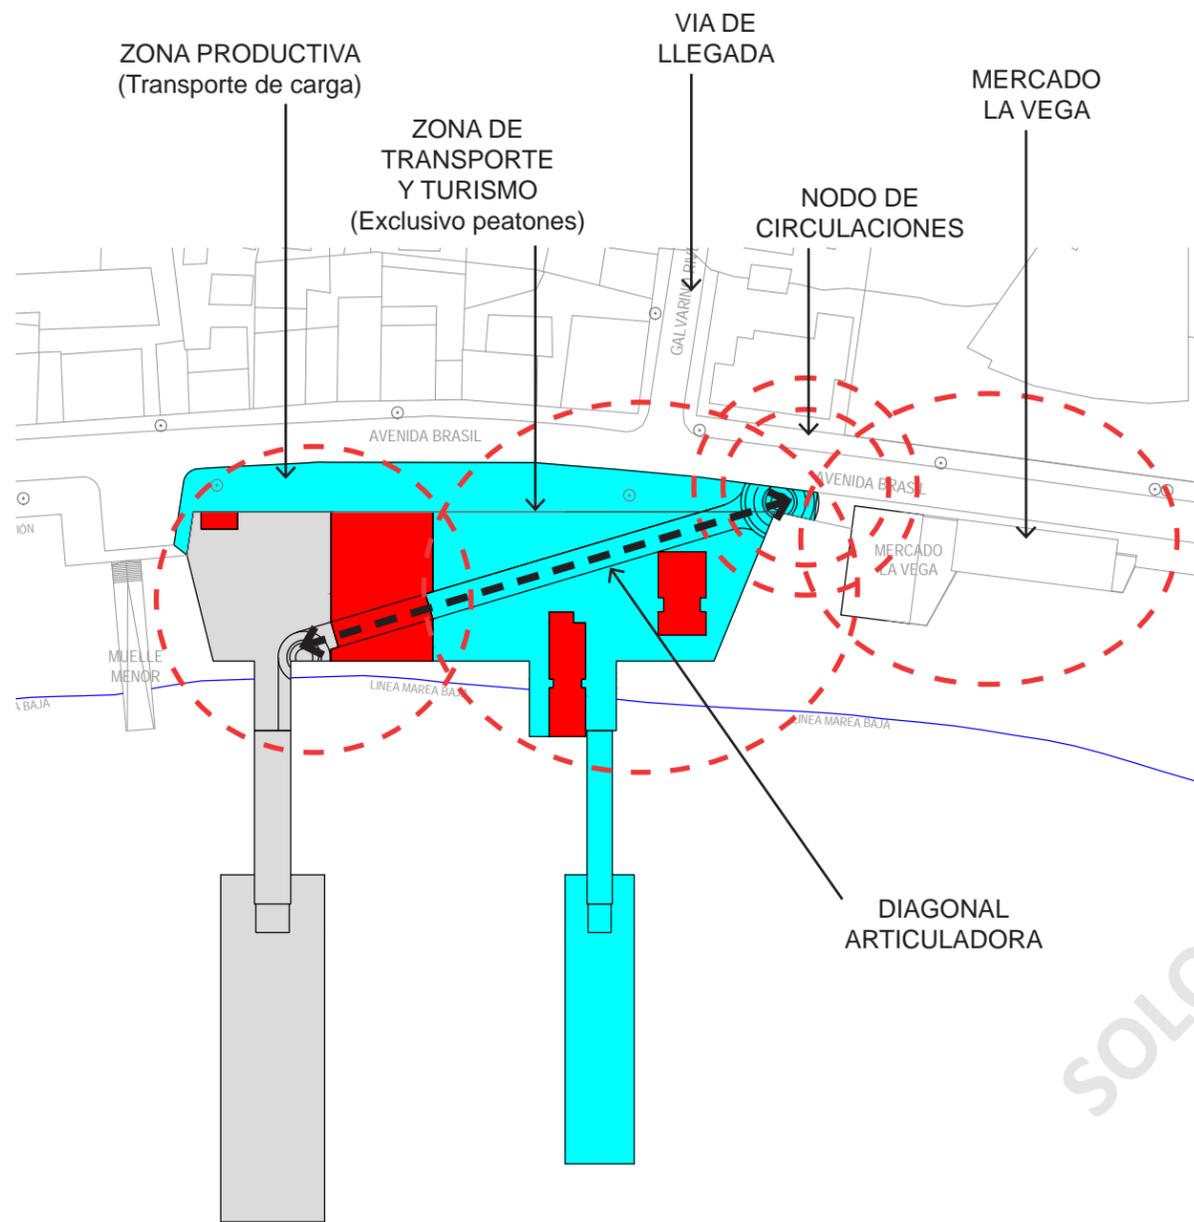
Elaboración propia. Plancheta Calbuco DOM.
